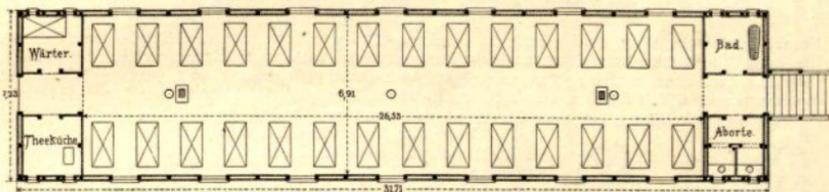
Grundriss der Baracken zu Aachen (Architekt A. Adenaw).
